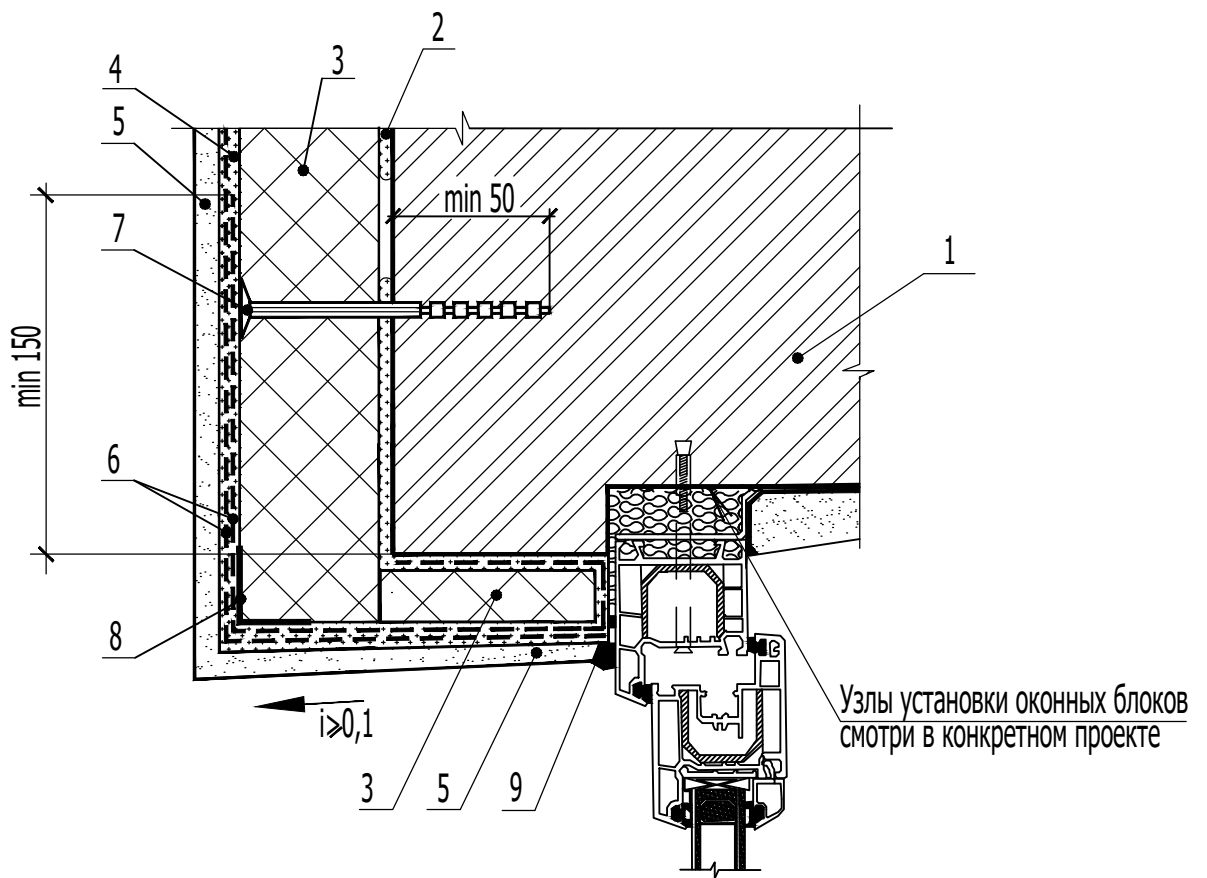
Узел отделки не утепленного верхнего откоса окна панельного здания
